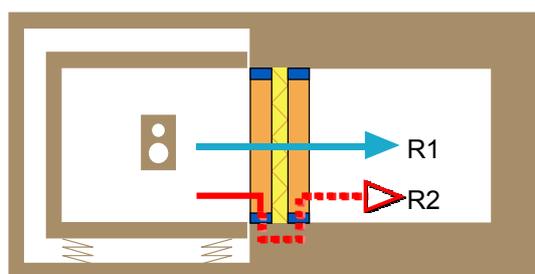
La colocación de bandas elásticas en el perímetro de las paredes minimiza el puente acústico estructural
